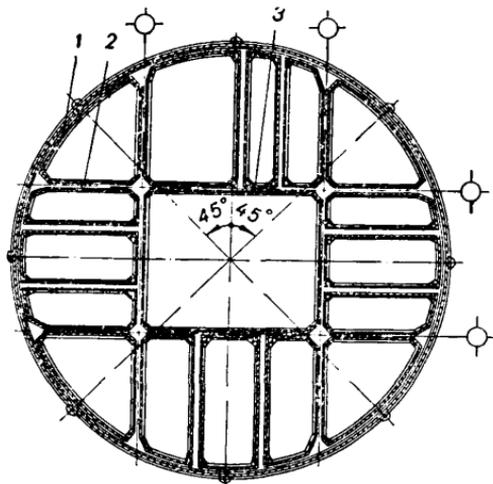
Схема расположения кружал в плане для копров круглой формы:
